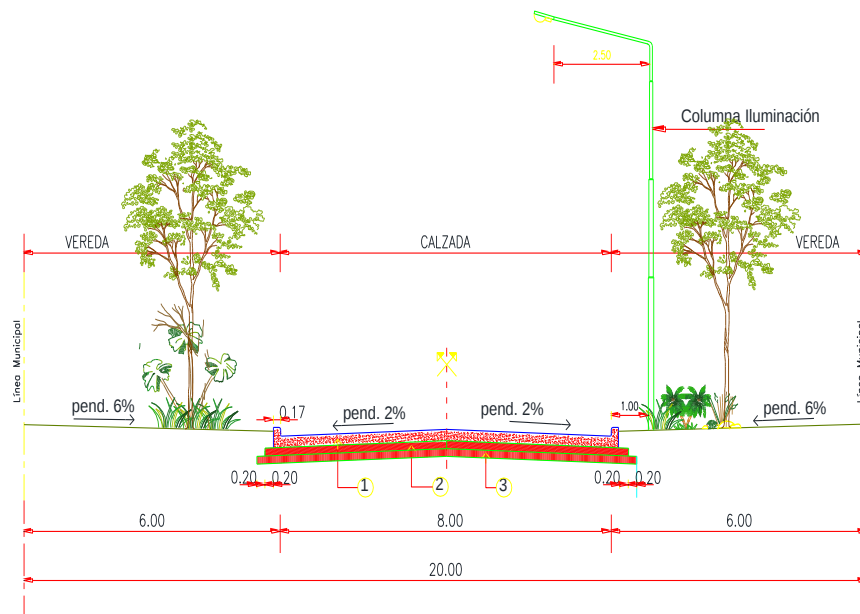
Perfil tipo calzada 8 m (fuente: elaboración propia).
